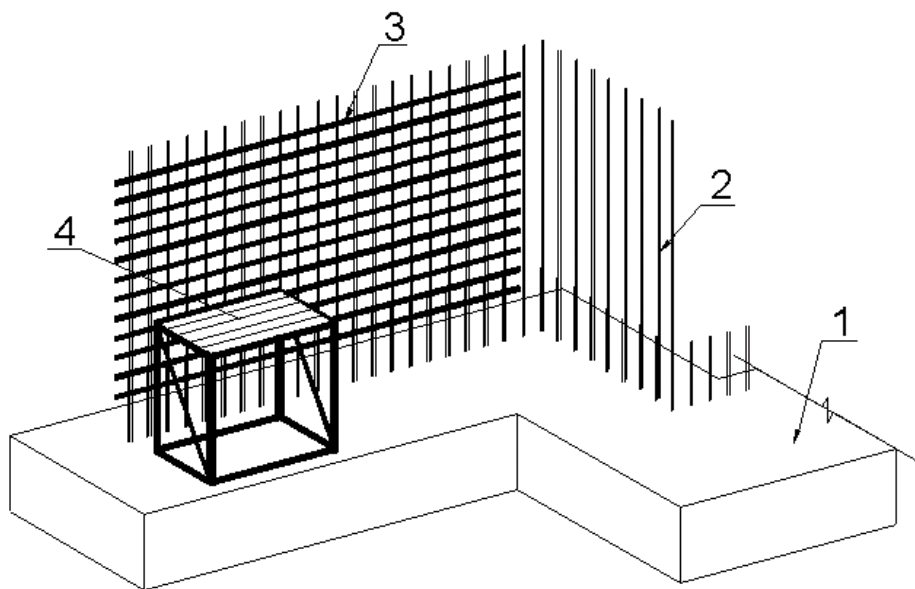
Армирование верхней части подпорной стены горизонтальными отдельными стержнями. 1 – готовая нижняя часть подпорной стены, 2 – вертикальные арматурные стержни, 3 – горизонтальные арматурные стержни; 4 – инвентарные подмости.
